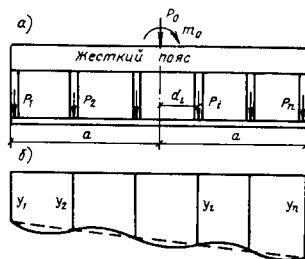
К расчету ленточного фундамента в случае связи колонн поверху жестким поясом
